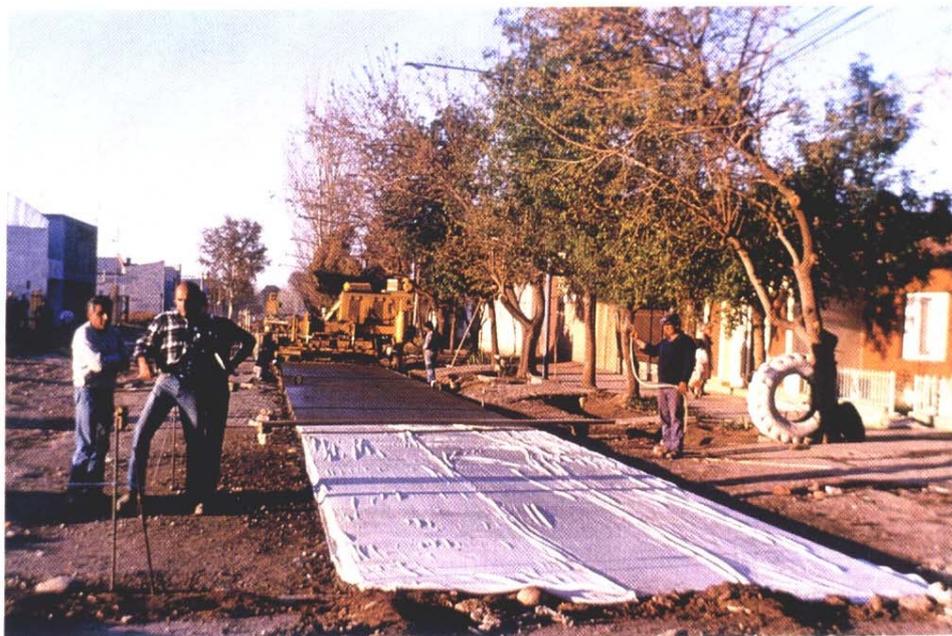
Recubrimiento del tramo de Godoy Cruz (Mendoza). Nótese al fondo la terminadora de moldes deslizantes y en primer plano el curado con polietileno.
